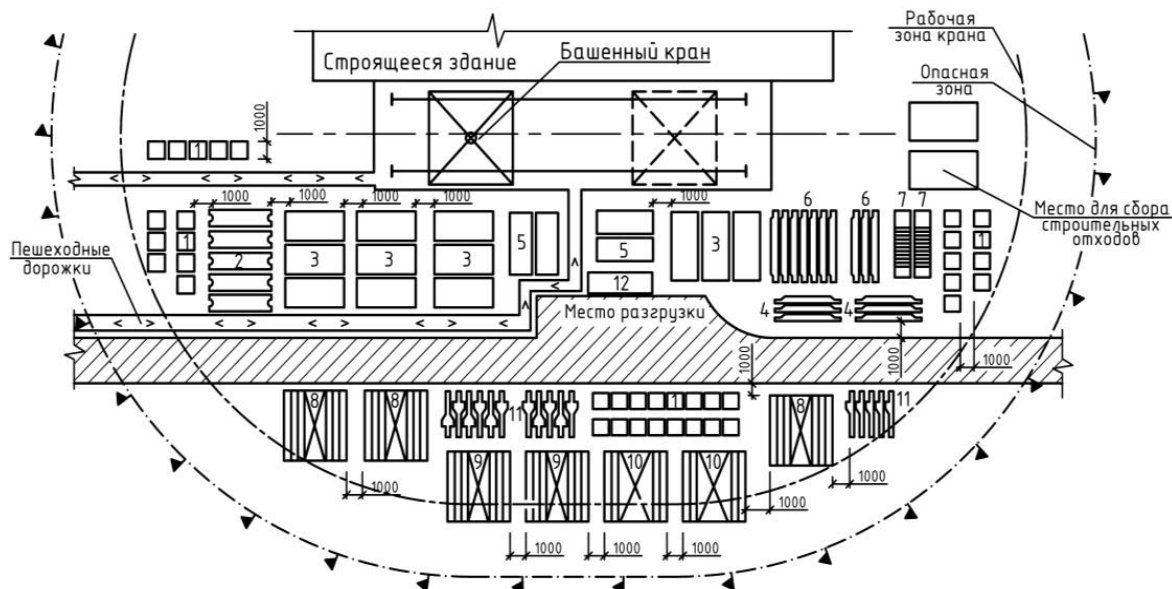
Примерный план размещения грузов на приобъектном складе: 1 – кирпич на поддонах; 2 – распорные плиты перекрытия (h до 2,5 м); 3 – пролетные плиты перекрытия (h до 2,5 м); 4 – распорные плиты крайние (h до 2,5 м); 5 – стены жесткости (h до 2,5 м); 6 – ригели (h до 2 м); 7 – лестничные марши (h до 2 м); 8 – стеновые панели в пирамиде (h до 2 м); 9 – витражи в пирамиде; 10 – перегородки в пирамиде с укрытием от атмосферных осадков; 11 – колонны (h до 2 м); 12 – площадка для кантовки конструкций
